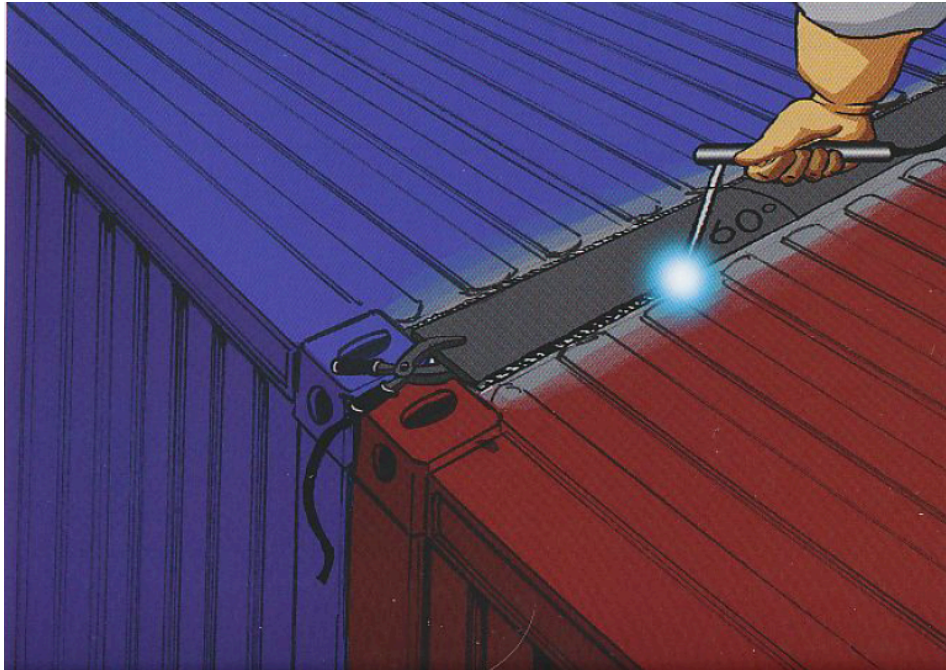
Technique de soudure pour containers (FOSSOUX et CHEVRIOT, 2011)
